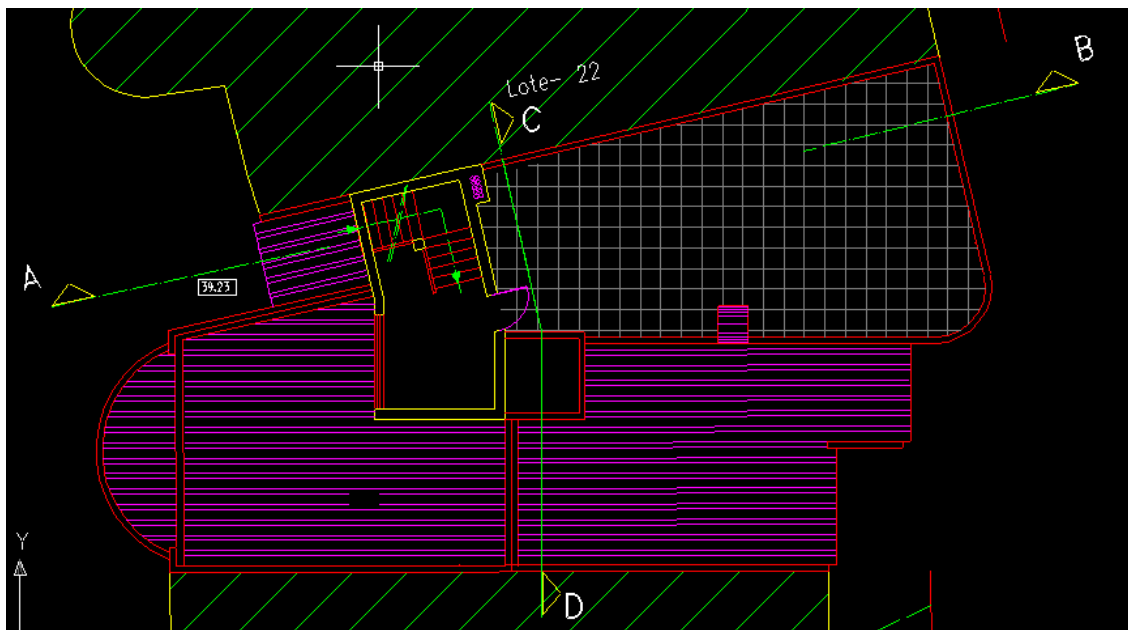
Planta do Piso Cobertura (Nova Faceta)
